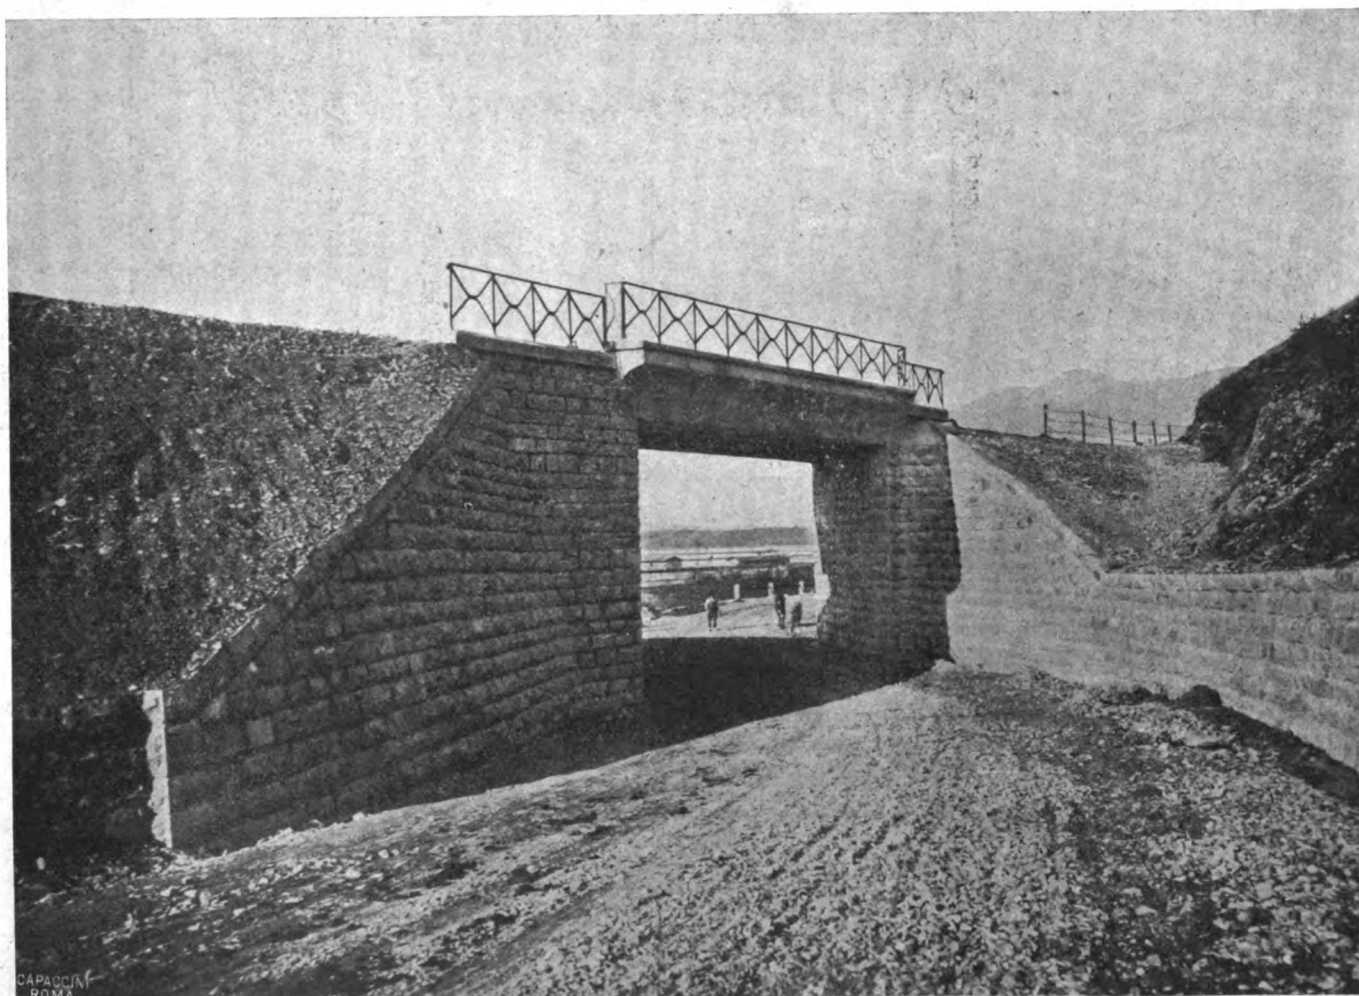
Cavalcavia in cemento armato presso Provaglio.
